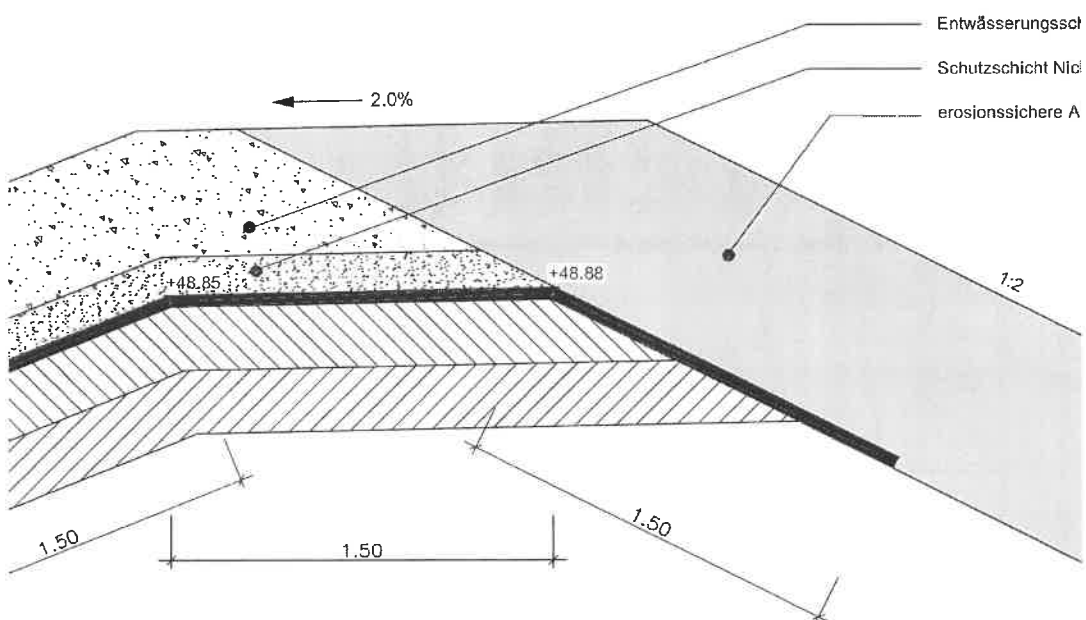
Detail Verwallung (aus Ausführungsplanung Bestand)
